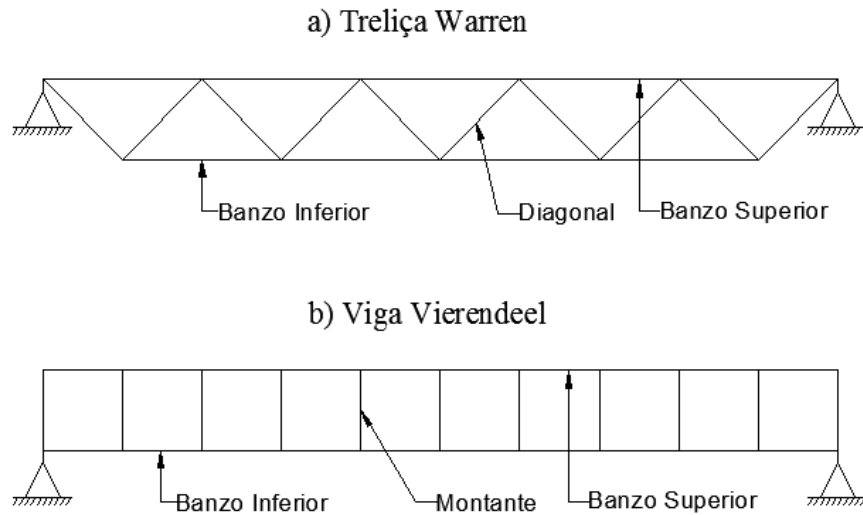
Elementos constituintes da Treliça Warren e da Viga Vierendeel
